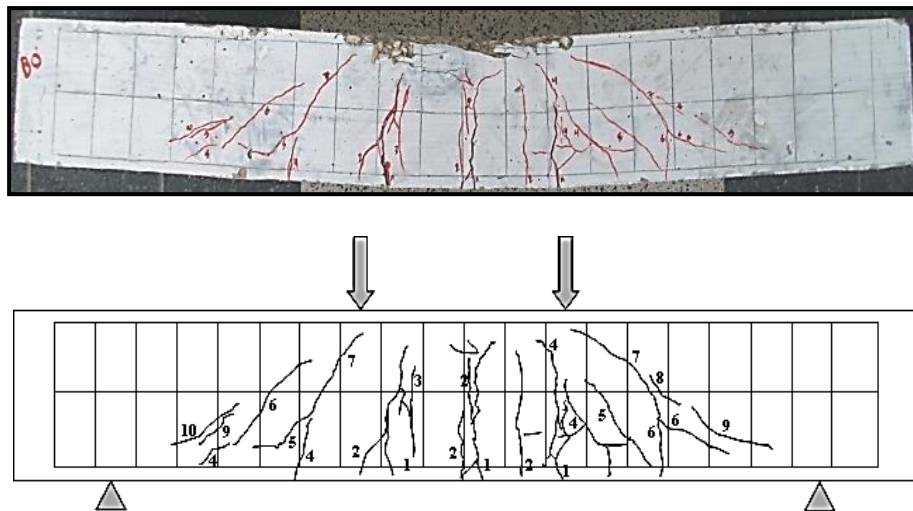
Destruction et fissuration finale de la poutre PBO avec At.
